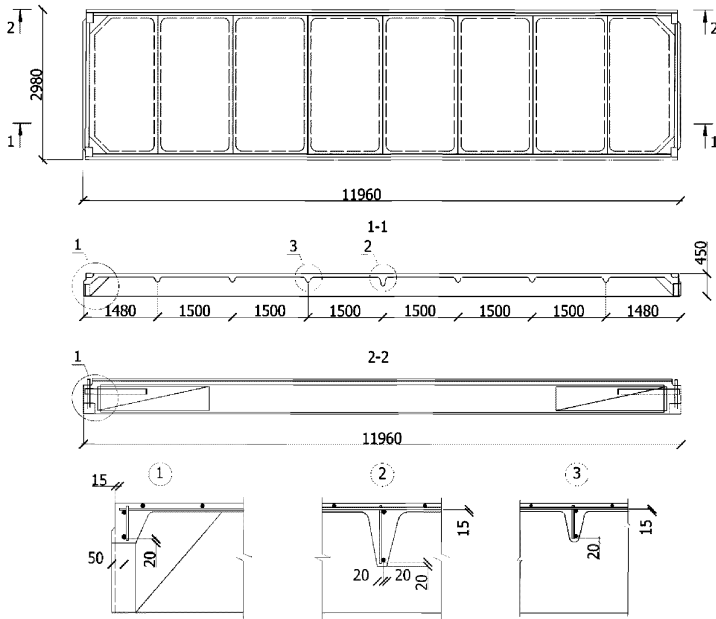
Схема армирования плиты размерами 12×3 м
